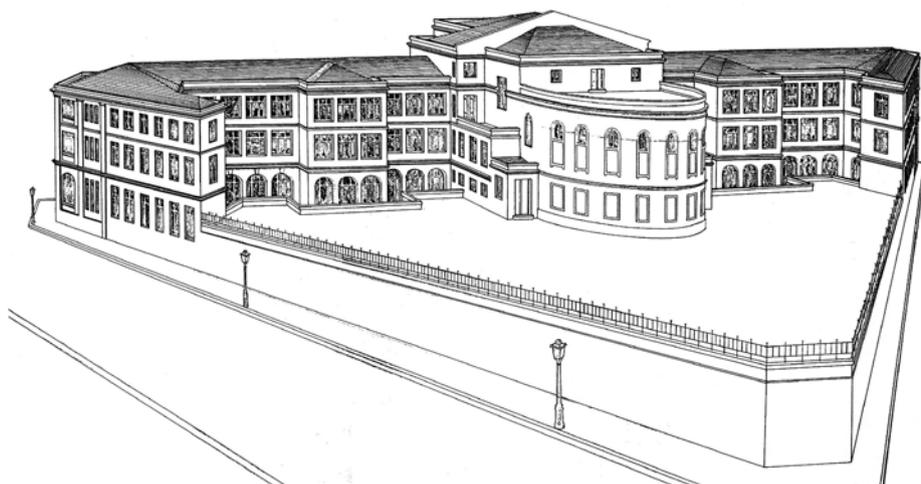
Grupo *Menéndez Pelayo*. Primera versión. Fachada posterior.
